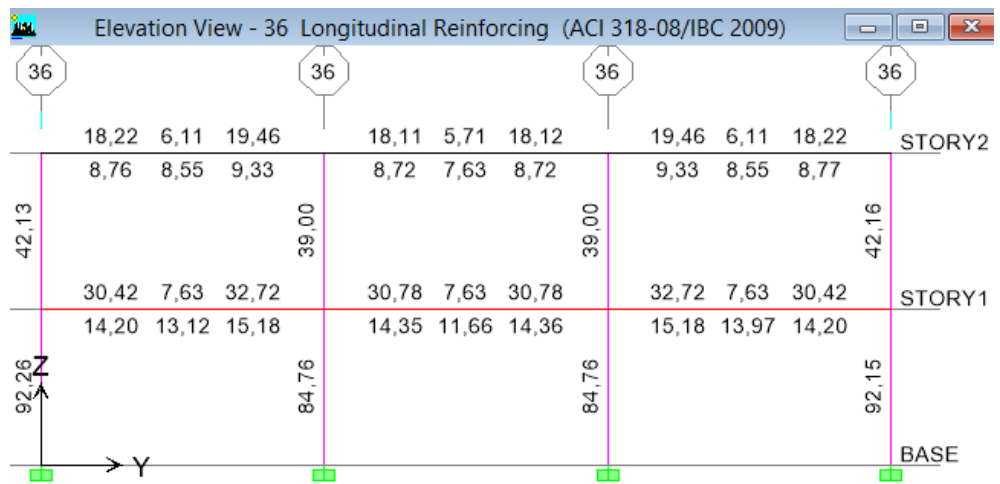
Acero en Vigas y Columnas en el Pórtico 36 – Obstetricia - (NEC-11)
